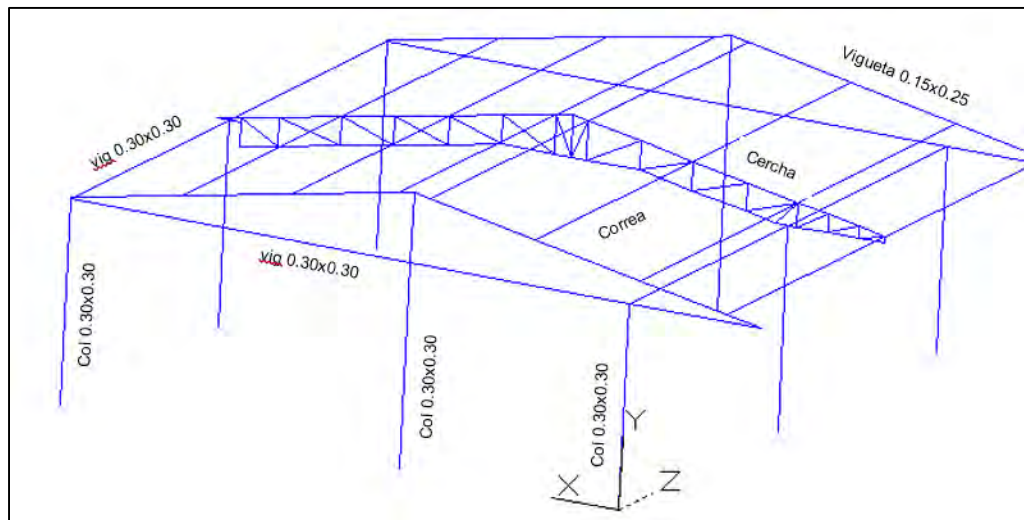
Configuración de elementos estructurales.
